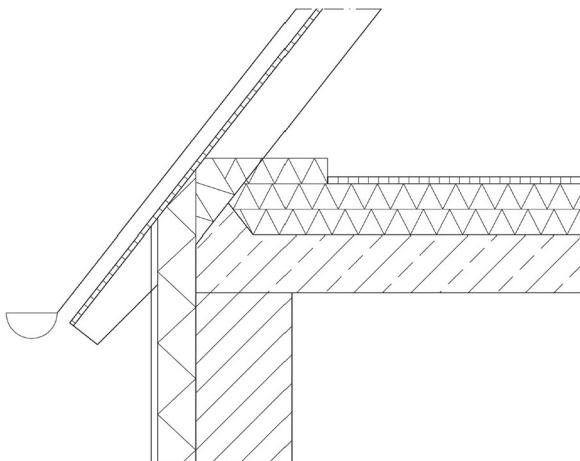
Dämmen einer Stahlbetondecke (Quelle: C. Uske)
